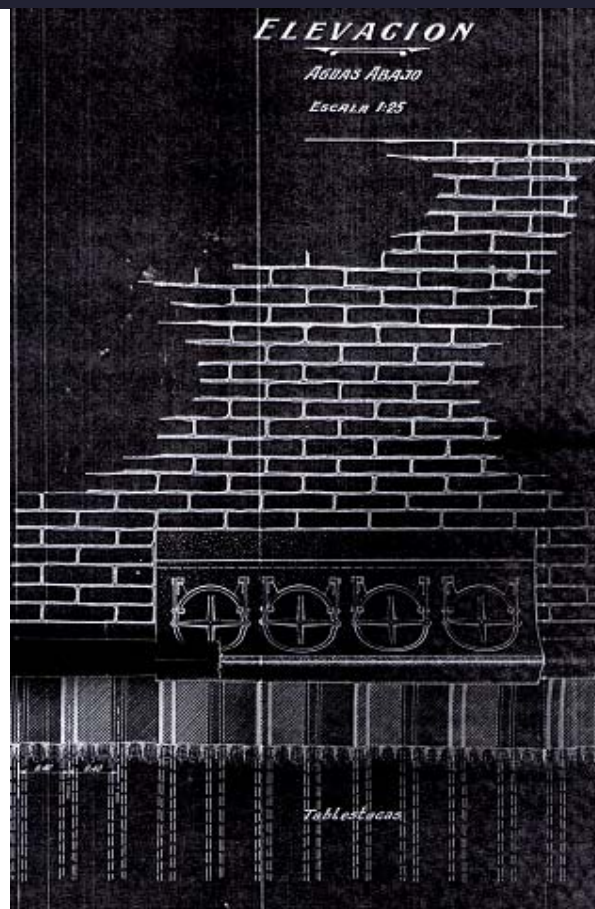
Alcantarilla de 4 bocas con detalle de válvulas exclusas y tablestacas
